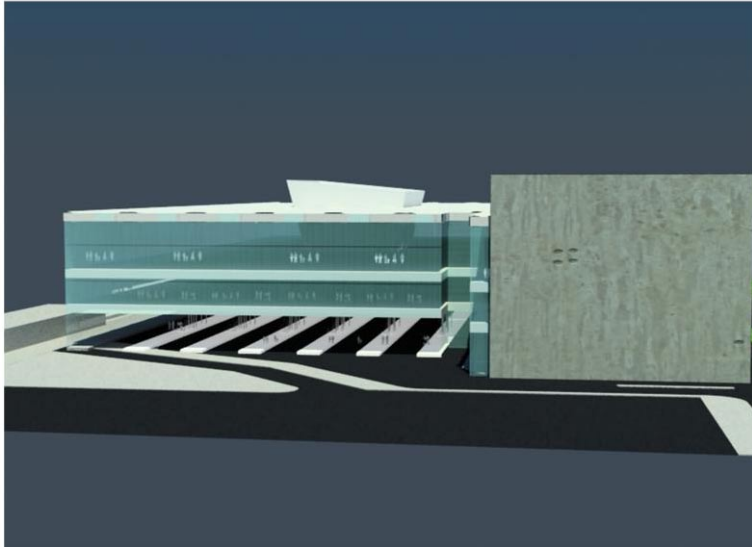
Anteproyecto de la SETRAVI para la modernización de los paraderos.
